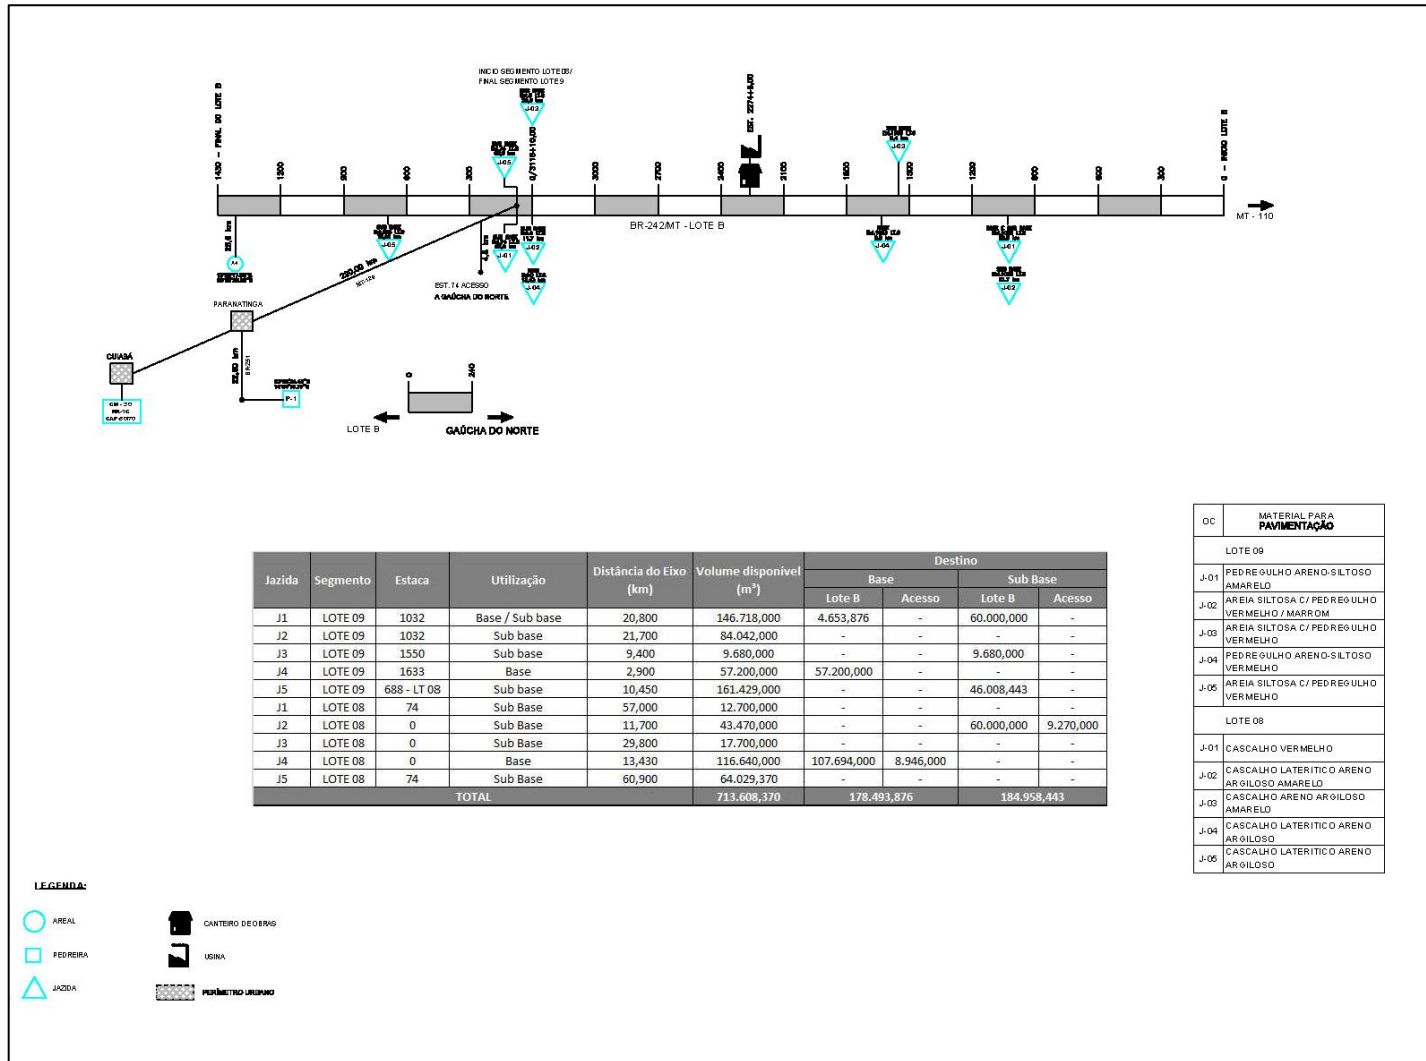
Diagrama da localização das fontes de materiais para a pavimentação e as instalações industriais (Segmento B – lote 09).
